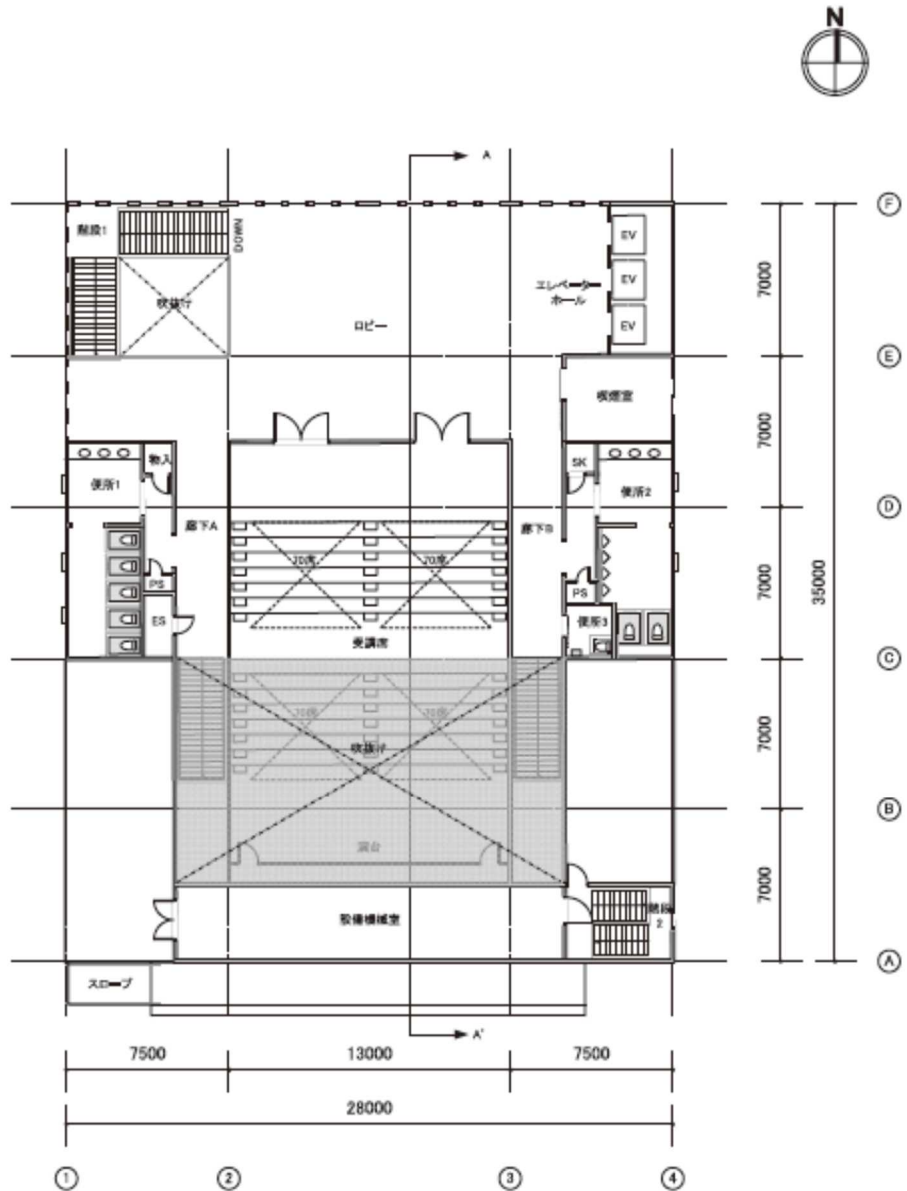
2 モデル建物（大学等、低層棟） 2階平面図
